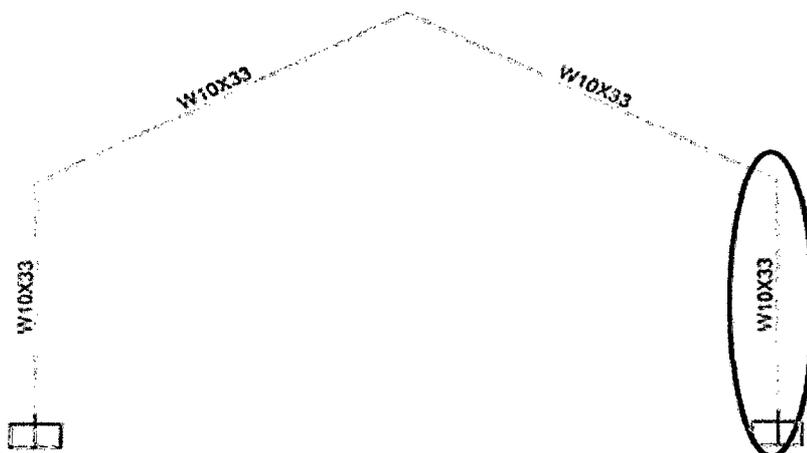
Deflexión de viga debida a Cargas de Servicio
